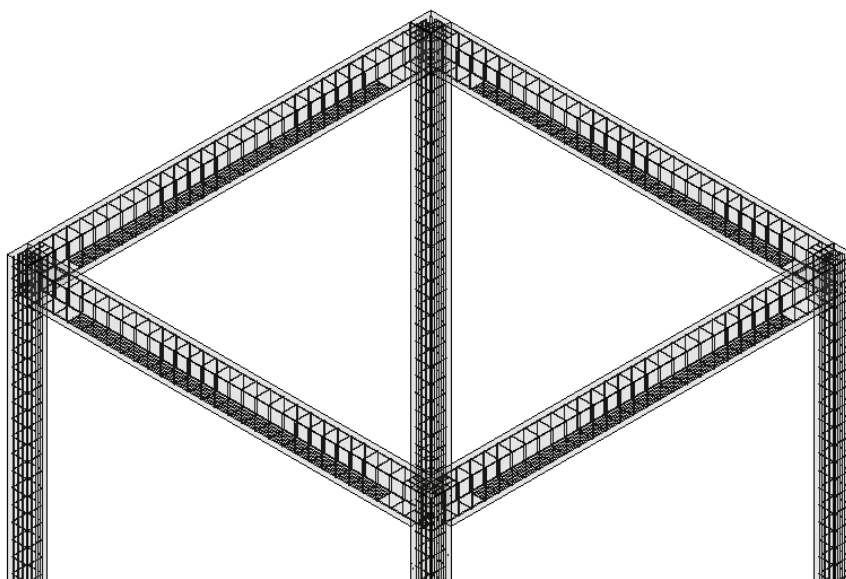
Vista conjunta dos modelos de armaduras de vigas com os dos pilares
